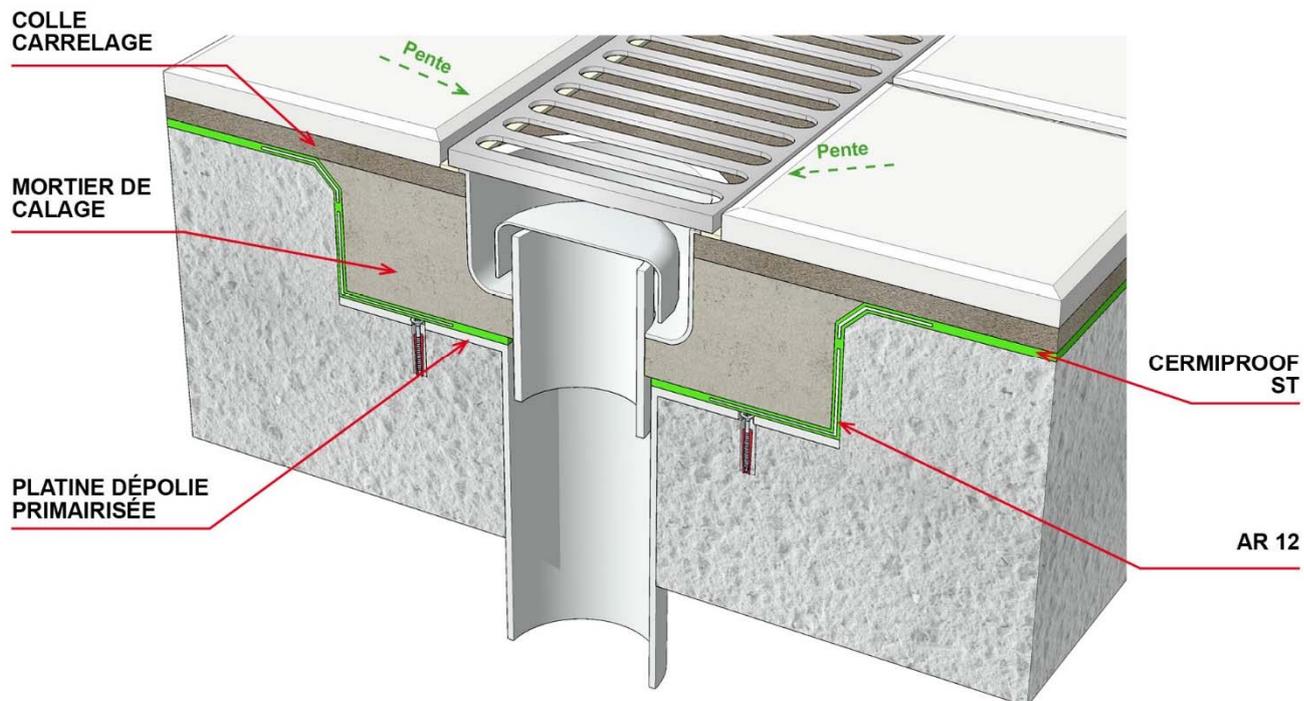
Raccordement à un dispositif d'évacuation des eaux : Siphon en pose collée
